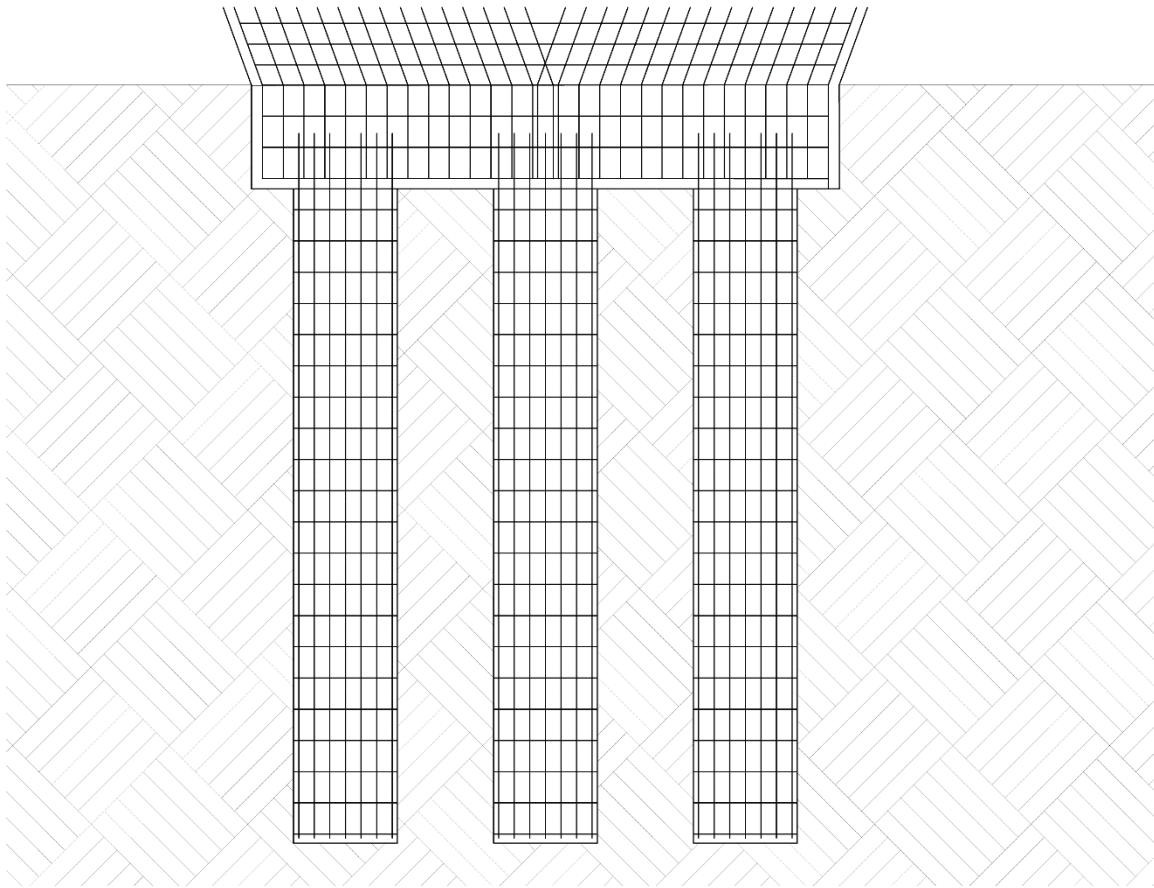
Corte de la cimentación. Elaboracion propia, (AutoCad).
